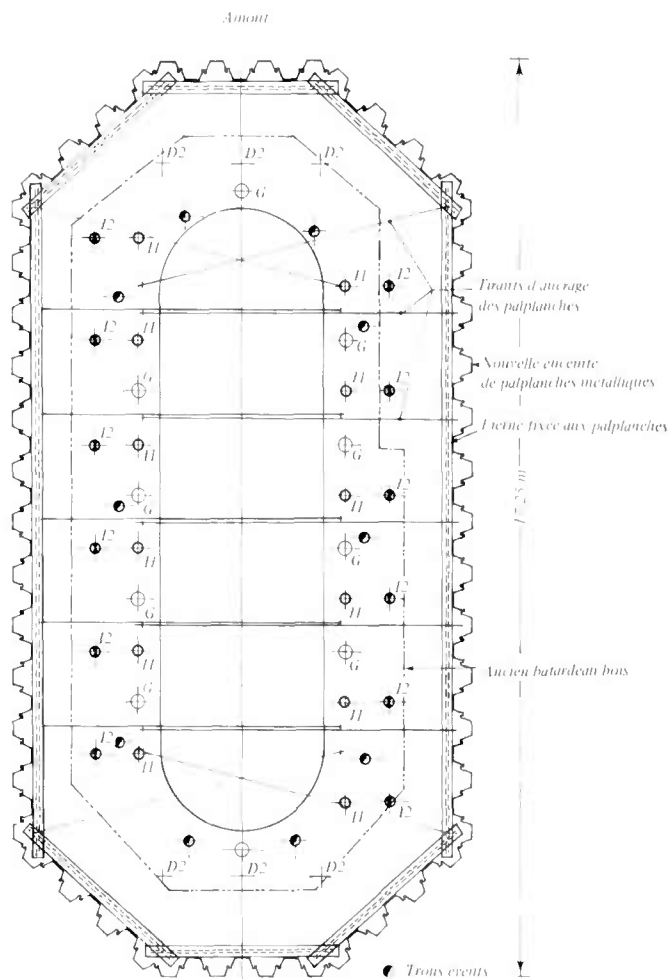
Vue en plan : implantation du batardeau et des forages d'injection.
